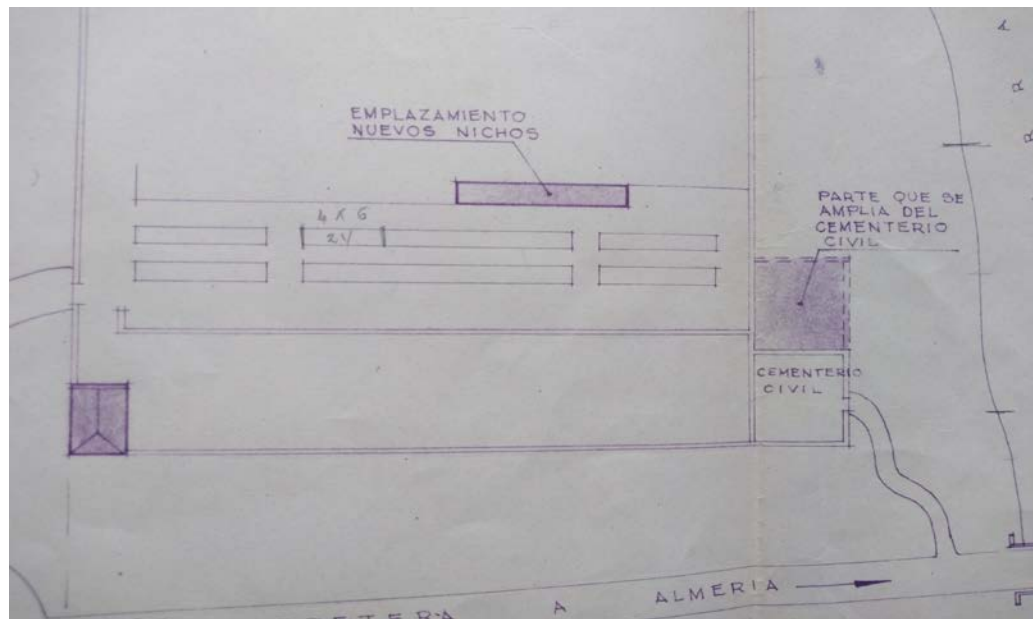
Detalle del plano de Reforma del Cementerio de Ugíjar, 1964.
